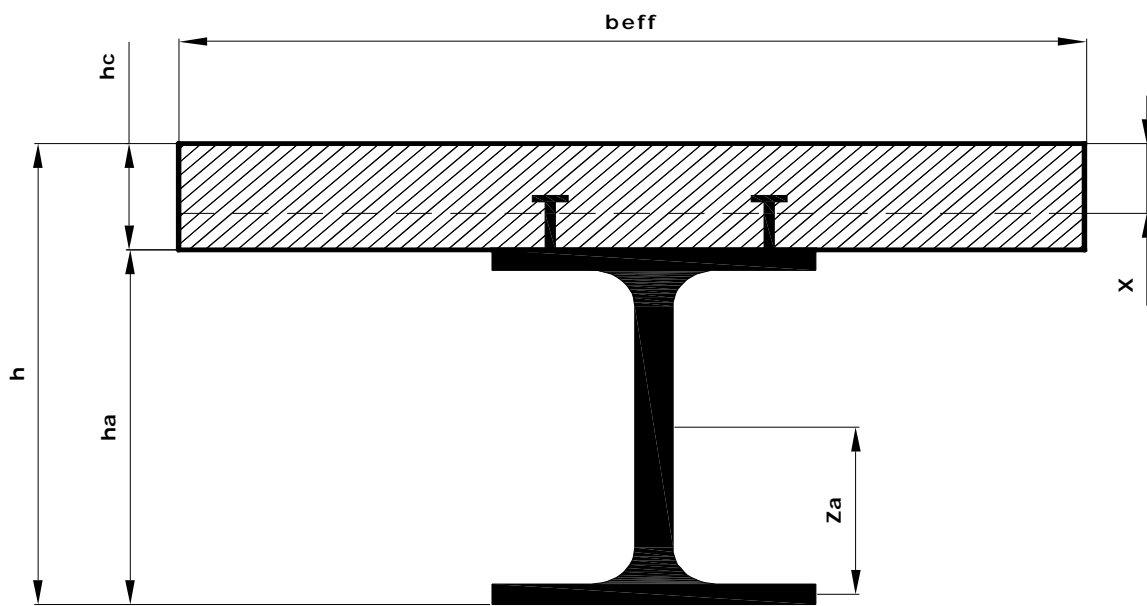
calcul de l'inertie d'une poutre mixte.
